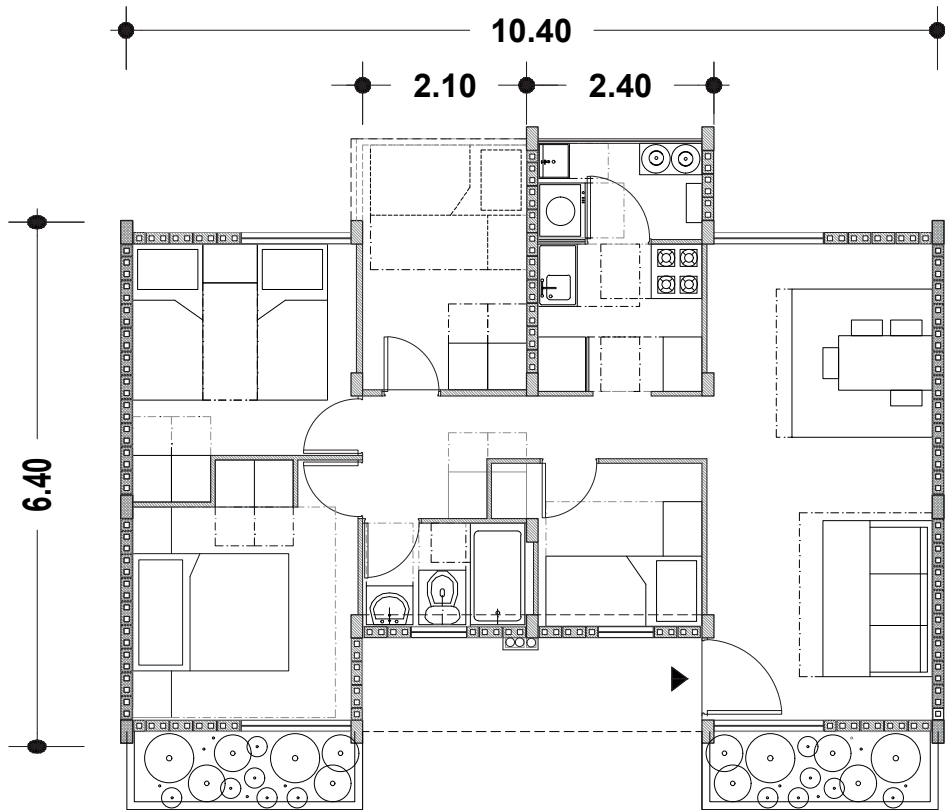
Vivienda tipo departamento Sin Escala. Elaboración Propia en base a planimetrías.
